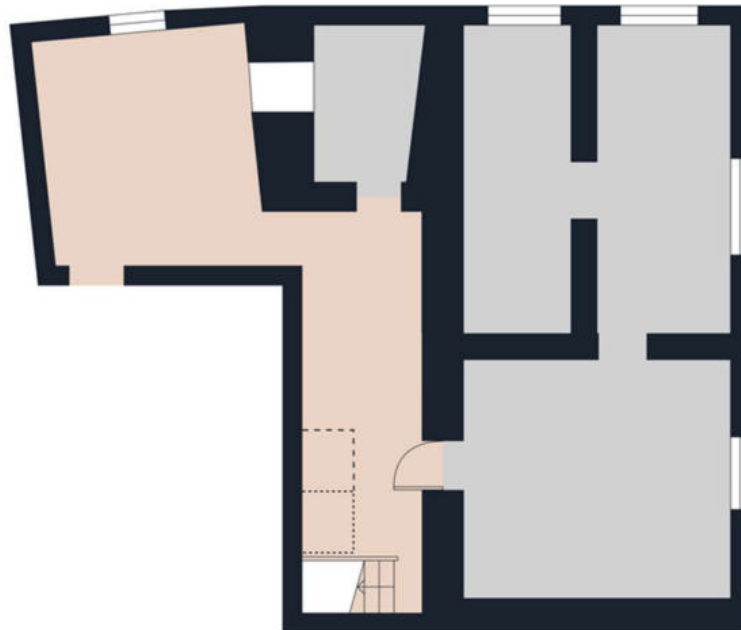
Grundriss Teilunterkellerung Lidar-Messgerät zum Stichtag 2025
